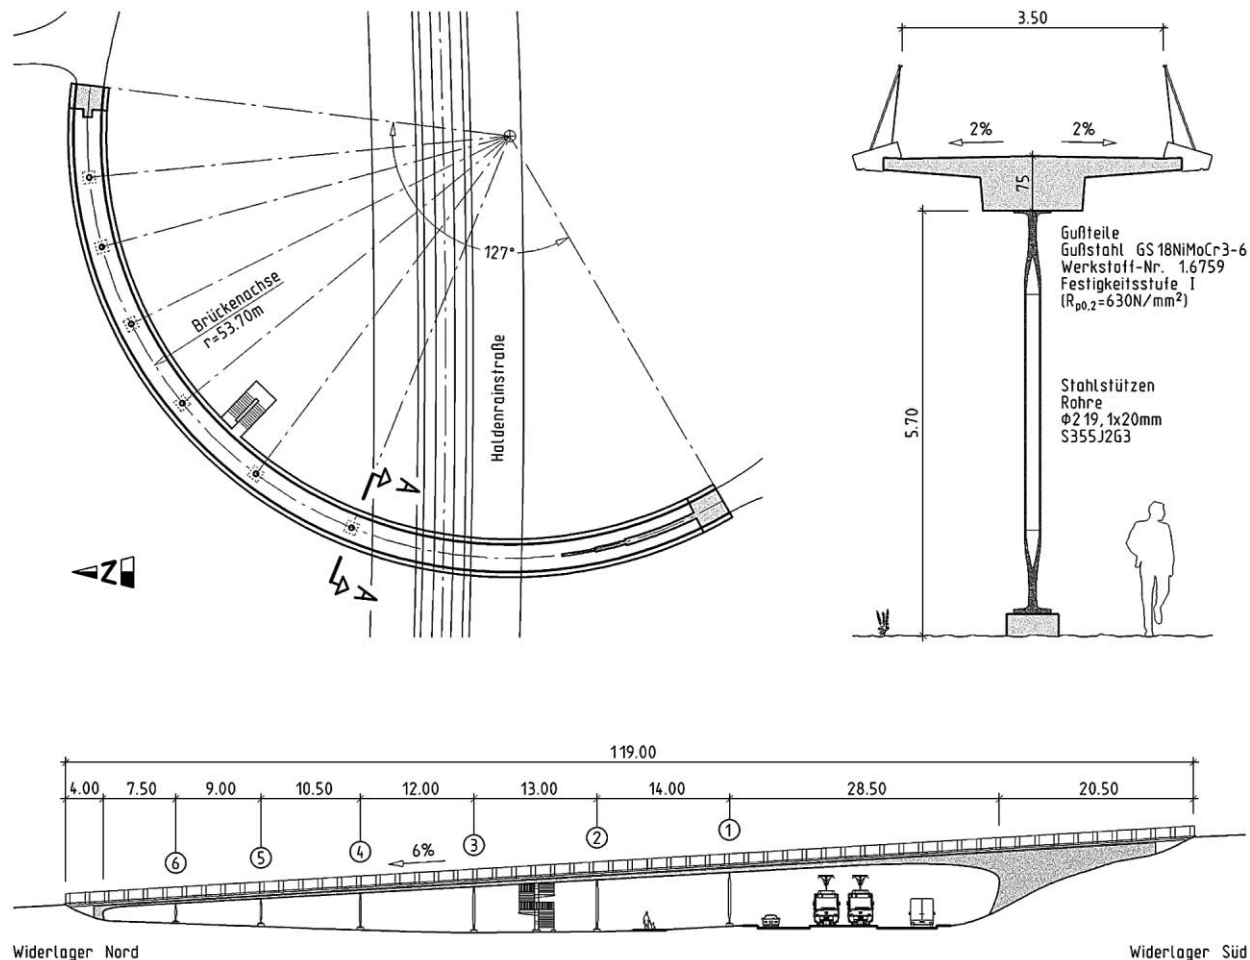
La-Ferté-Steg, Stuttgart: Grundriß, Querschnitt A-A und Abwicklung
